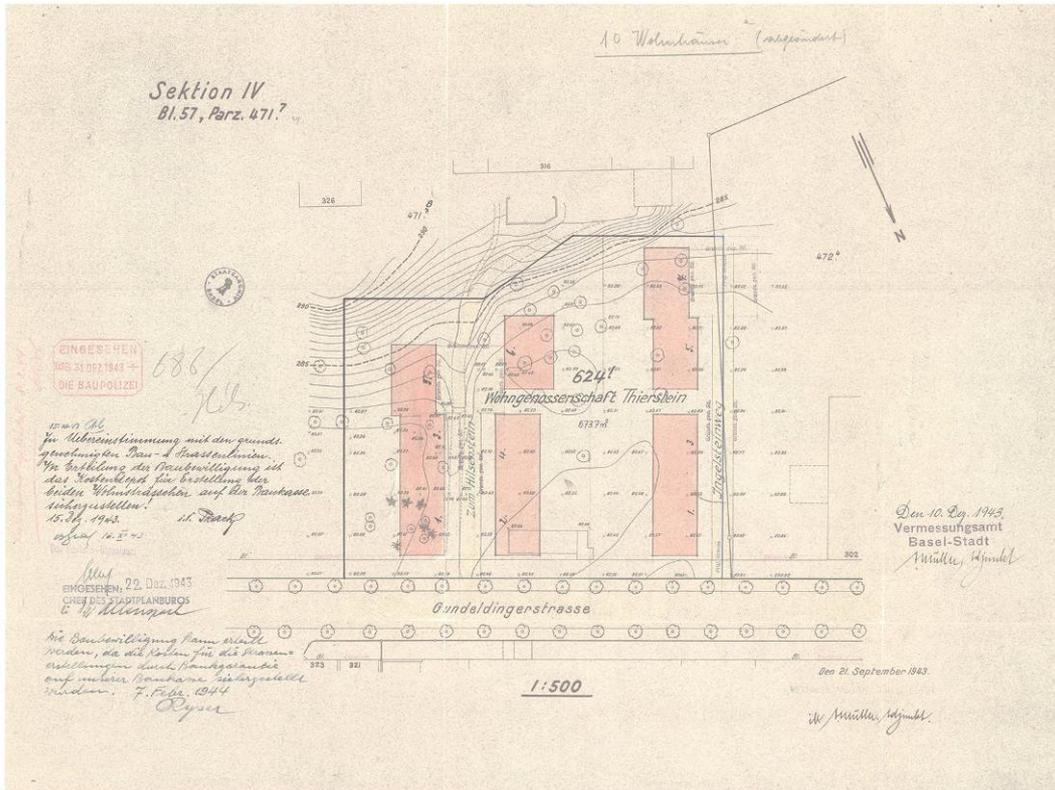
Baueingabeplan, Situation 1:500, Etappe 1, 1943. Architekturbüro von der Mühl und Oberrauch, 21.9.1943 [Quelle: StaB]
